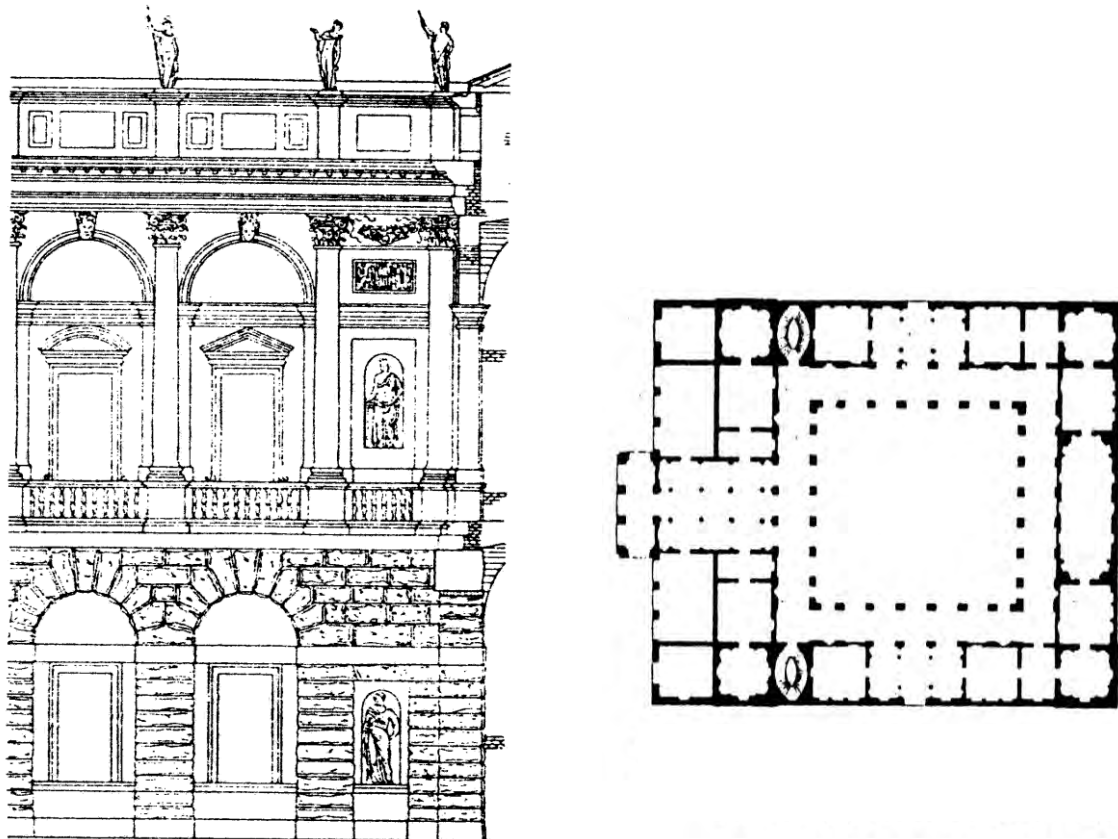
Палаццо Тьене. Фрагмент фасада, план
